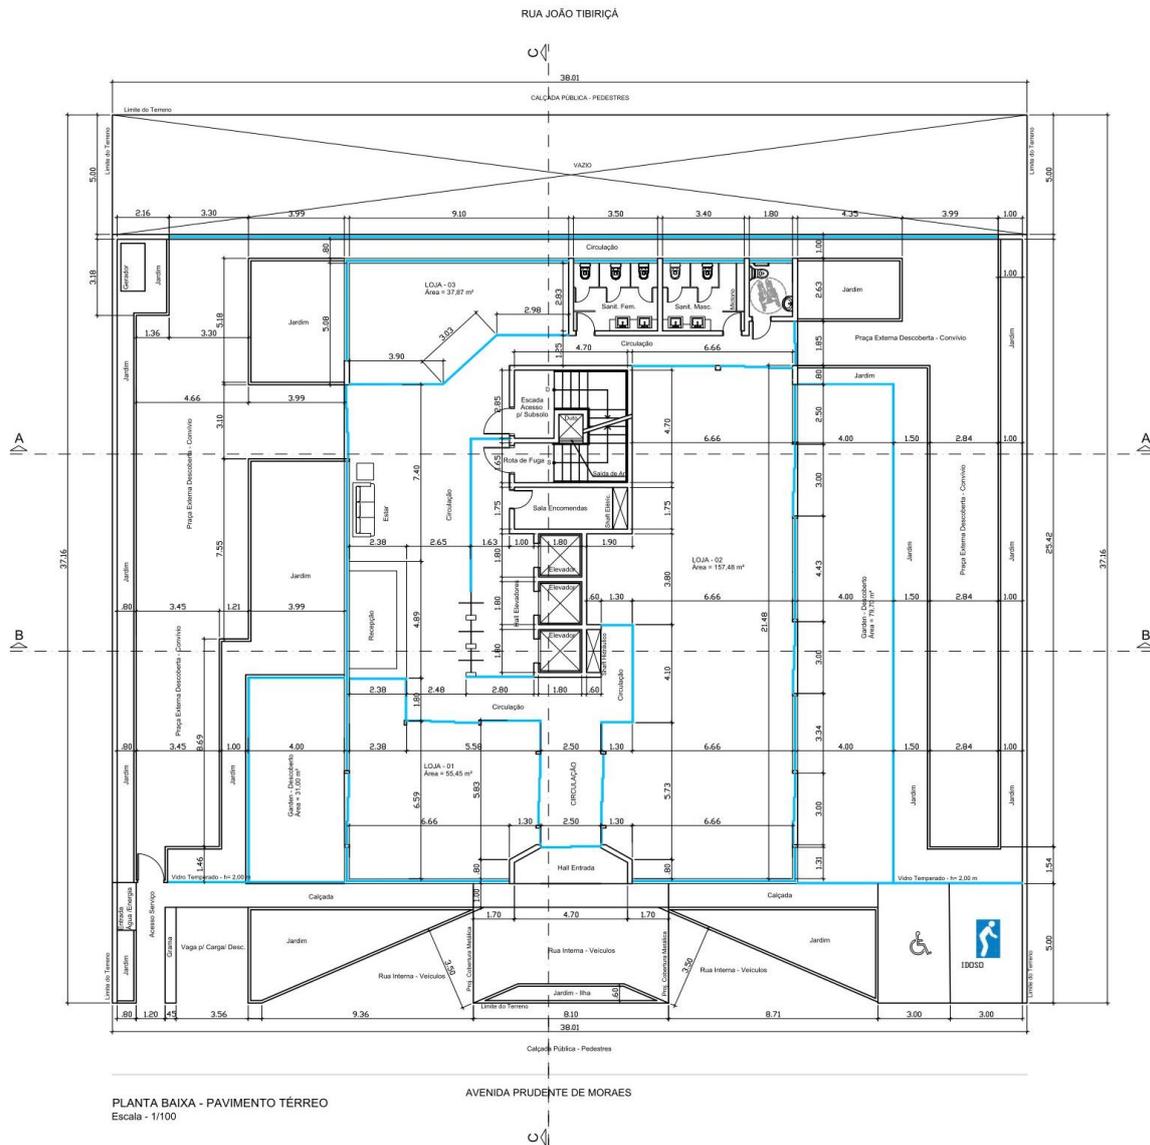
Projeto de implantação do empreendimento: pavimento térreo.
